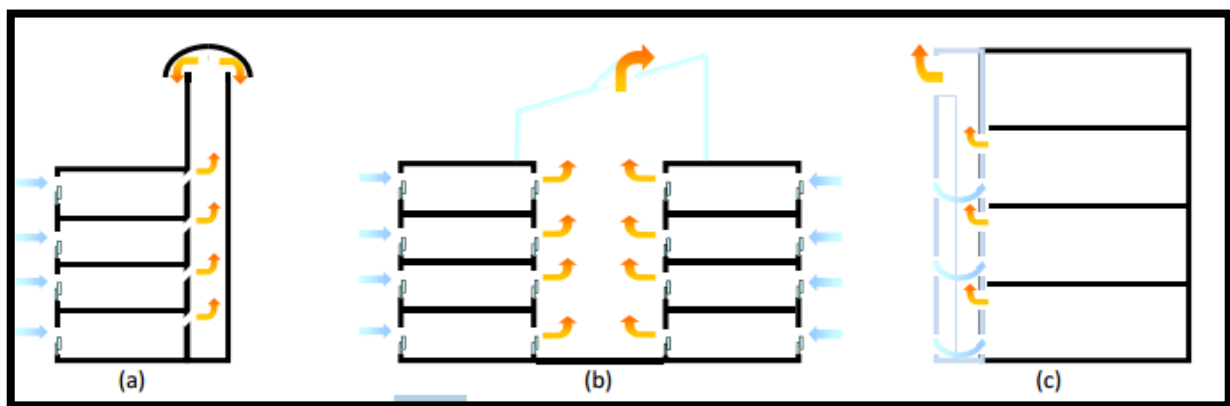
Exemple de solutions architecturales favorisant la ventilation verticale traversant.
